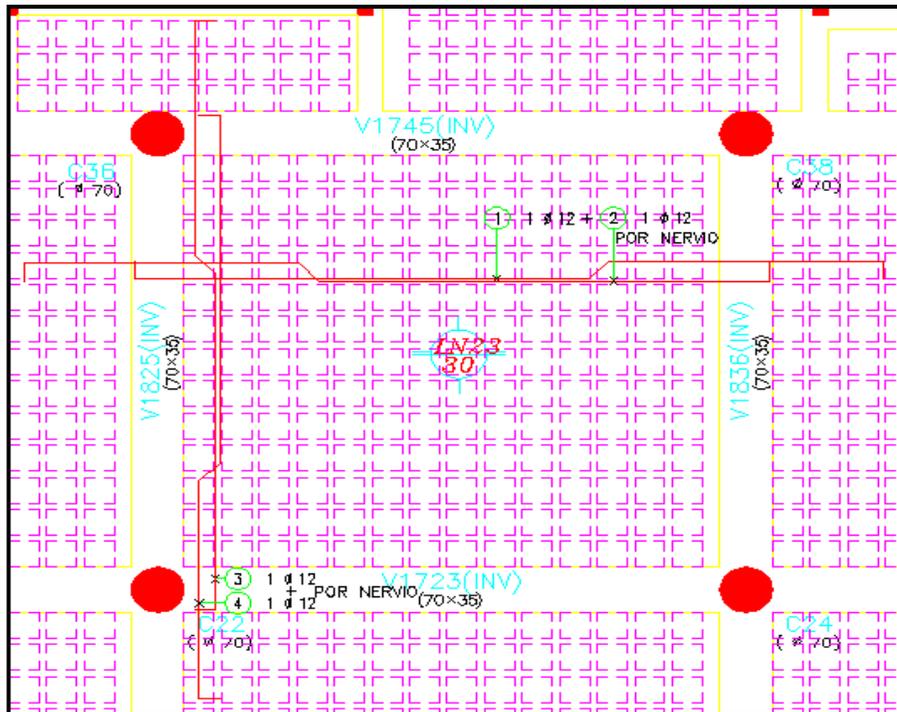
Detalle de armado de losa extraída de plano de estructuras
